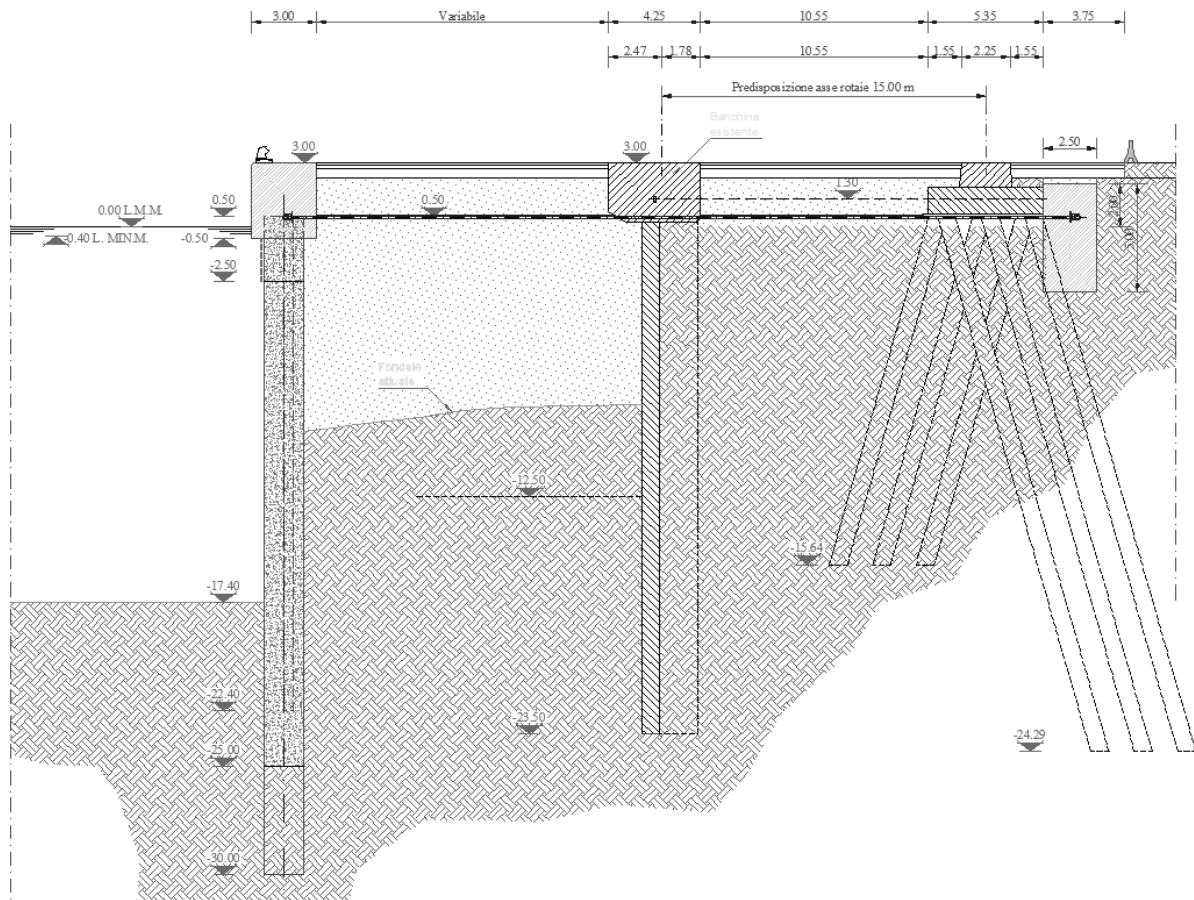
Sezione tipo del nuovo banchinamento G nel Segmento sud
